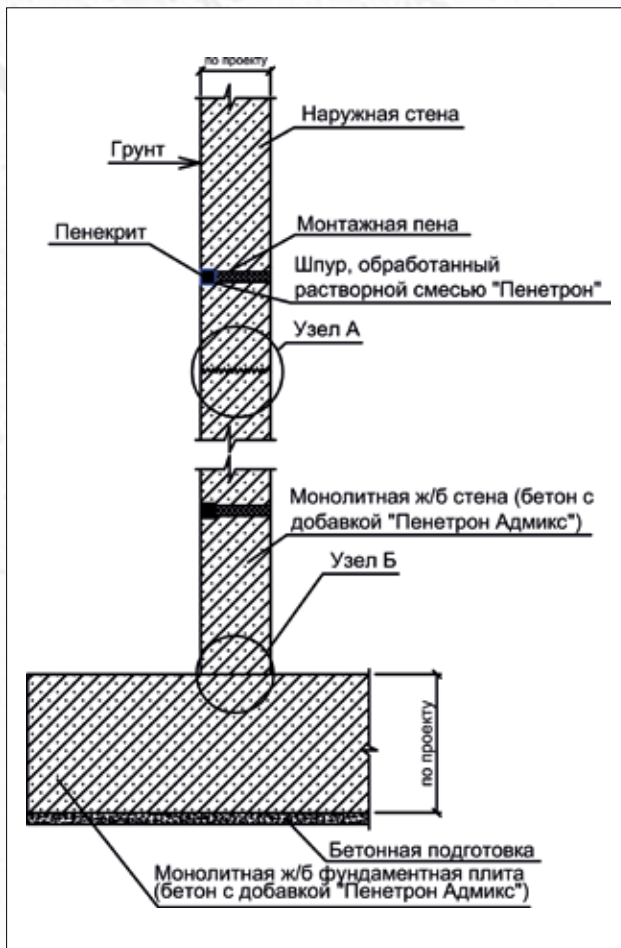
Общая схема устройства гидроизоляции бетонных конструкций
